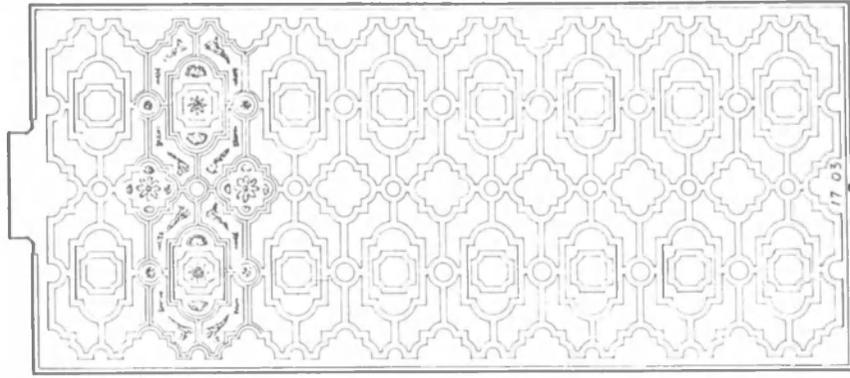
Plan du plafond de style Louis XIV, daté de 1703.
